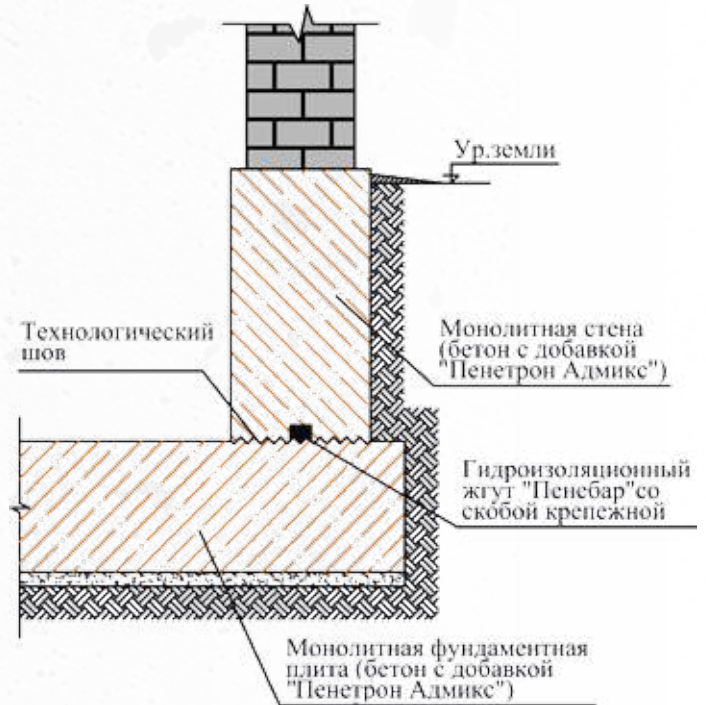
Гидроизоляция фундамента на стадии возведения
